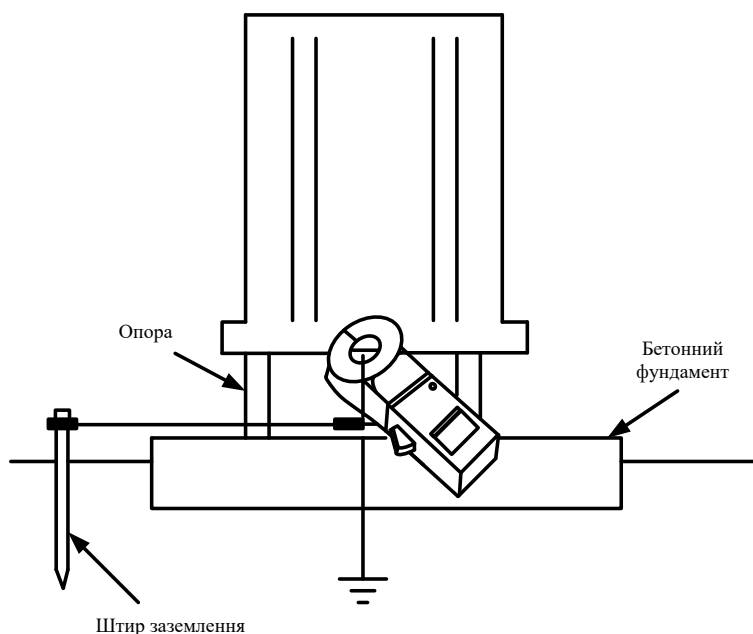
Стінка на бетонному фундаменті із зовнішнім провідником заземлення
